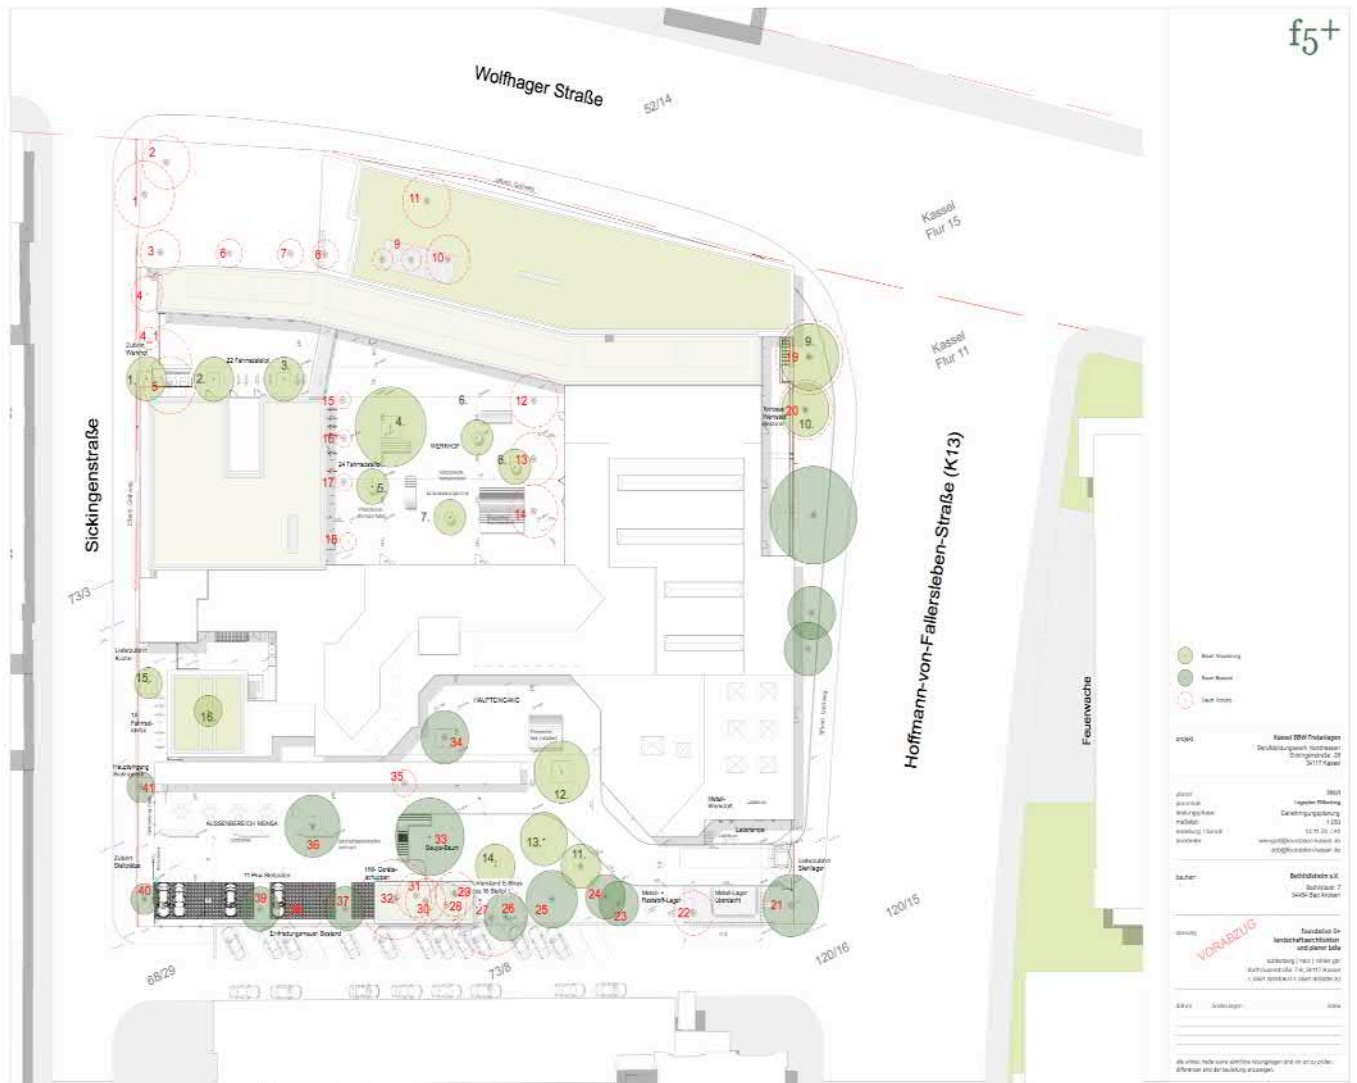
Bestandsplan Baumbestand (Fällantrag), Quelle: foundation 5+ Landschaftsarchitekten
